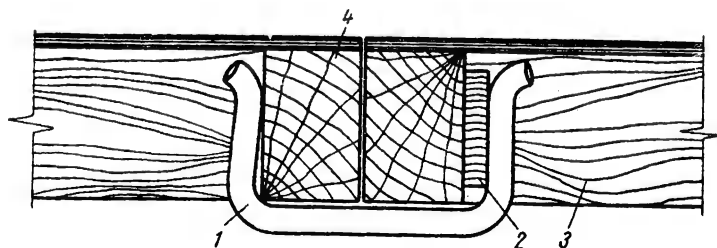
Asamblarea a două panouri de cofraj cu clemă și pană :
